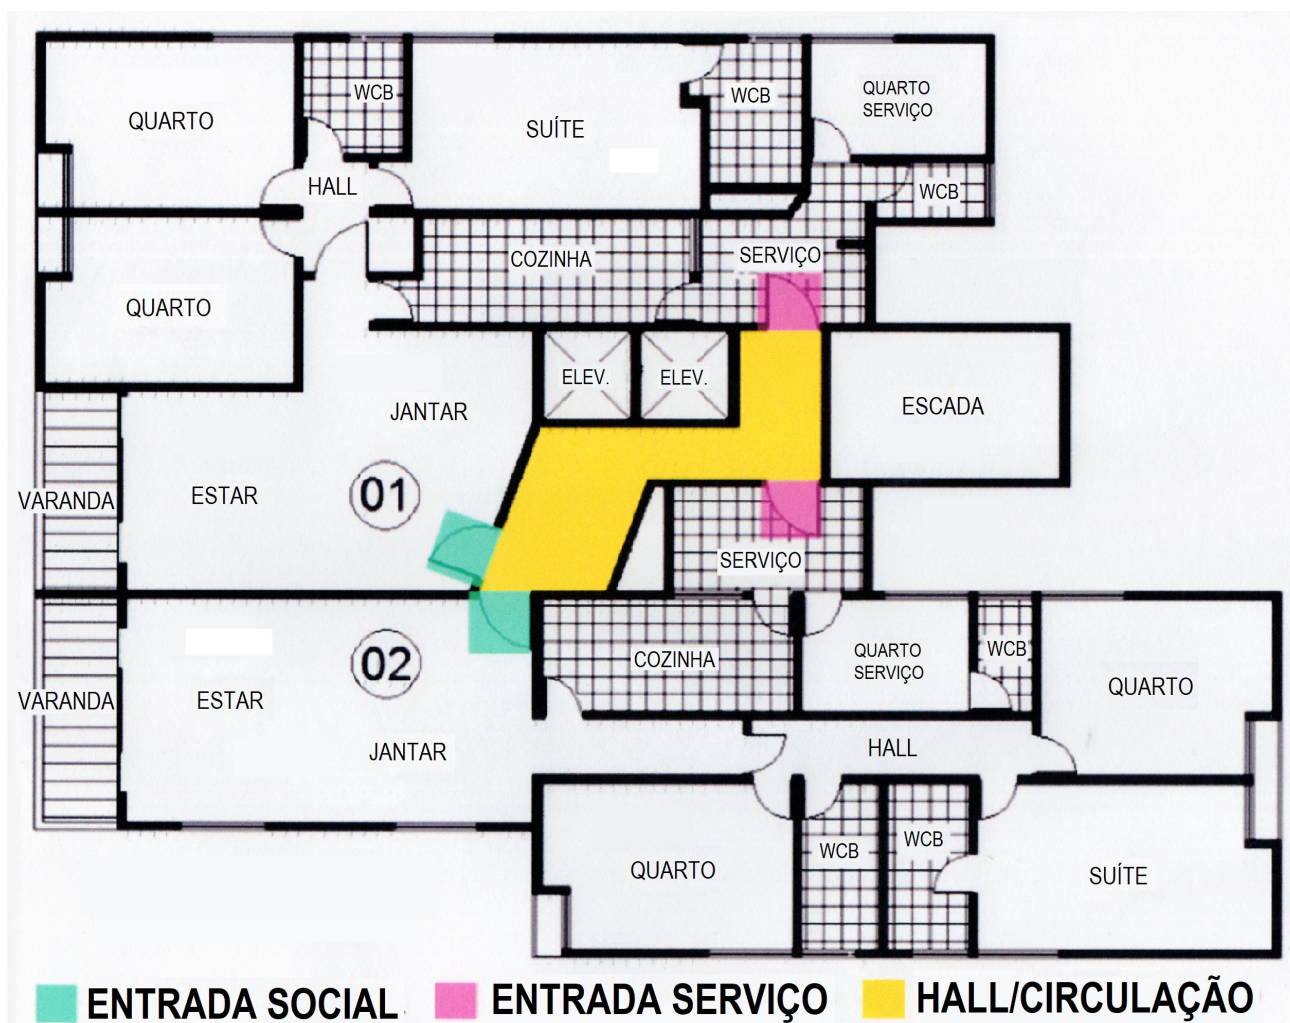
Planta baixa pavimento tipo do Edifício Paris (1986).
